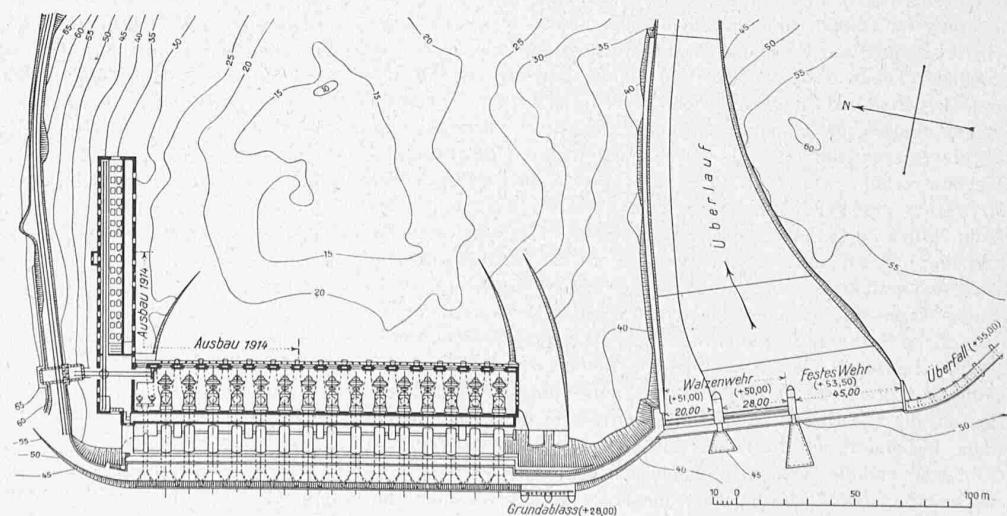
Lageplan des Kraftwerks an den Vamma-Fällen am Glommen. — Massstab 1:3000.
